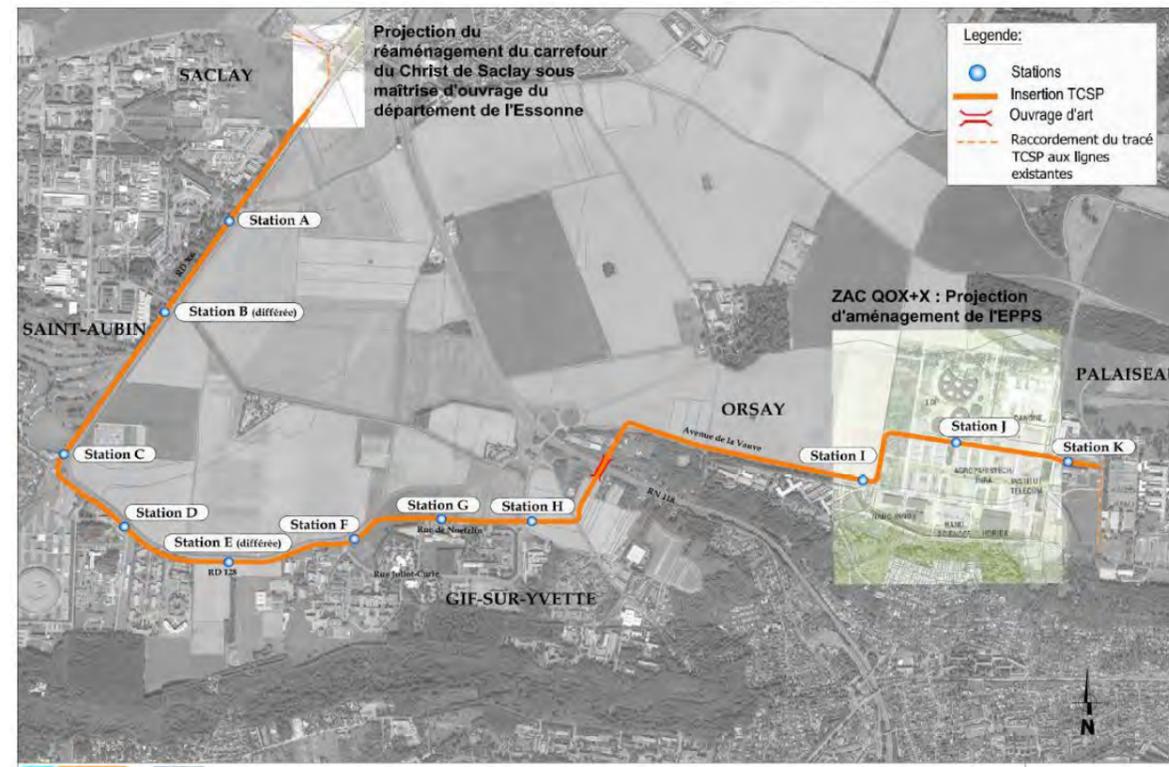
Plan général des travaux de projet de TCSP du plateau de Saclay
